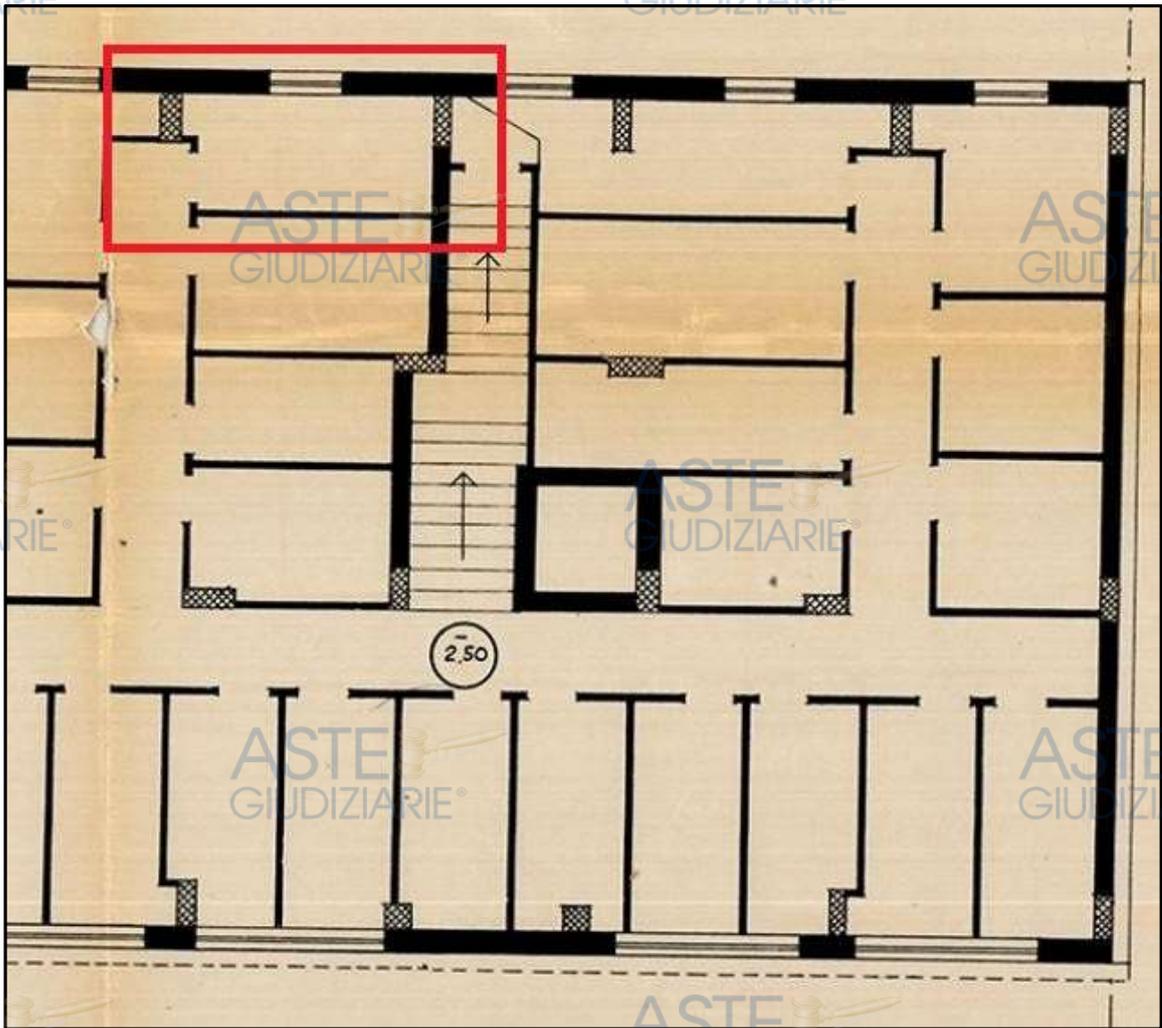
Estratto planimetria piano interrato (S.1.) licenza 11094 del 1958
